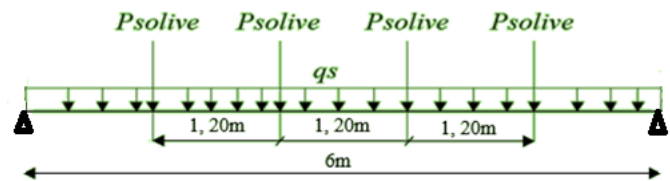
Schéma statique de la poutre maitresse sous chargement.
